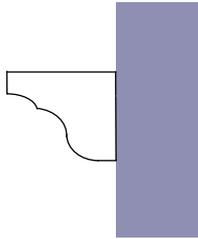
Humedad debida a una solución inadecuada entre la fachada y el alero de hormigón
